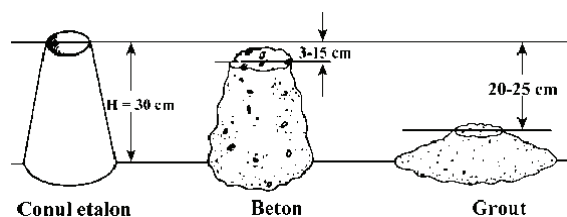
Comparația tasării pentru între beton și grout [Greenwald, J., Farny J. *Masonry Construction. Self-Consolidating Grout* Structure Magazine, May 2005]
